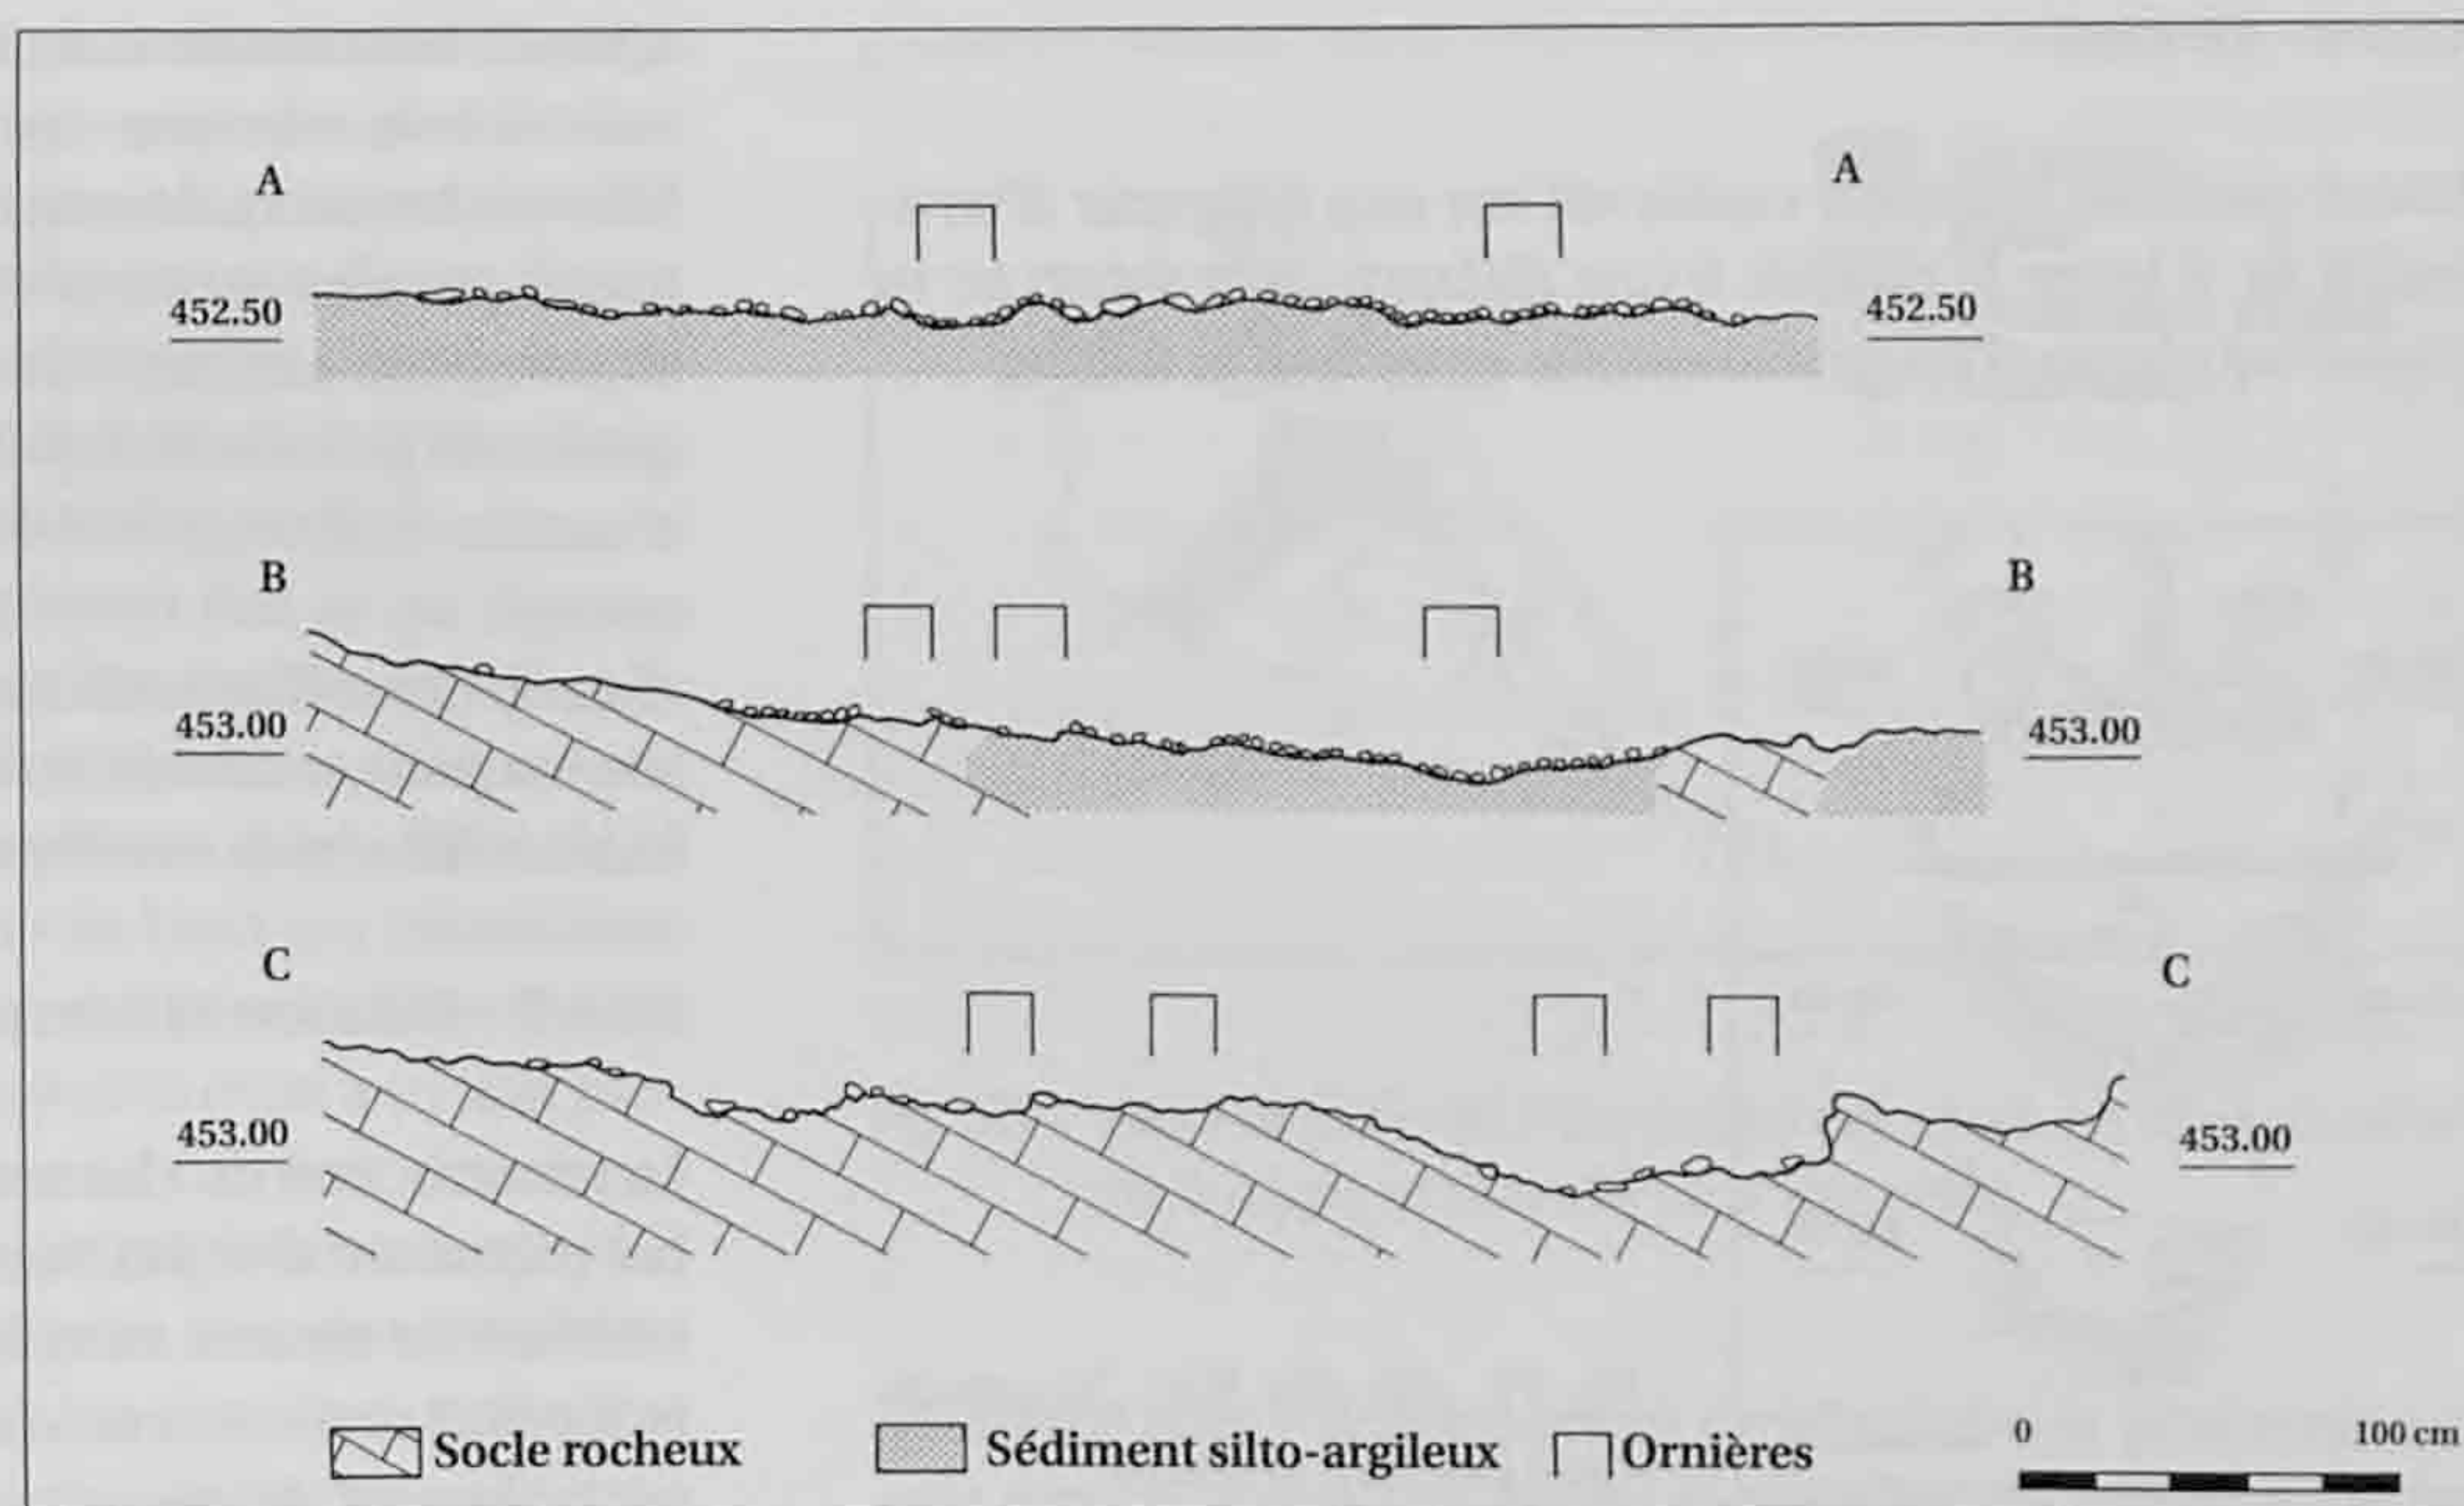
Alle, Noir Bois. Profils transversaux du chemin privé et emplacement des ornières, d'après les observations en coupe et en plan.
